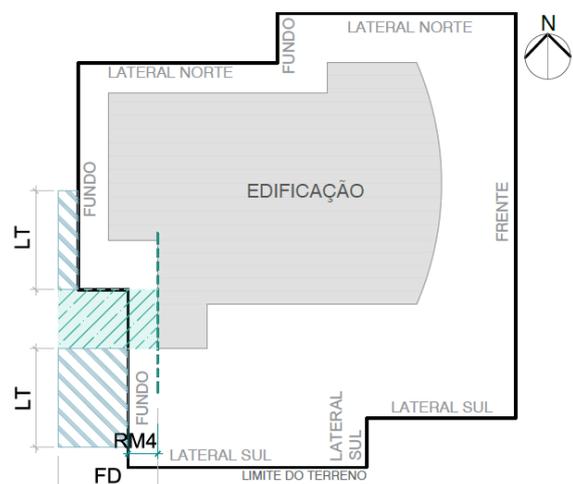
Planta esquemática da área de recuo virtual da 2ª face da fachada oeste
